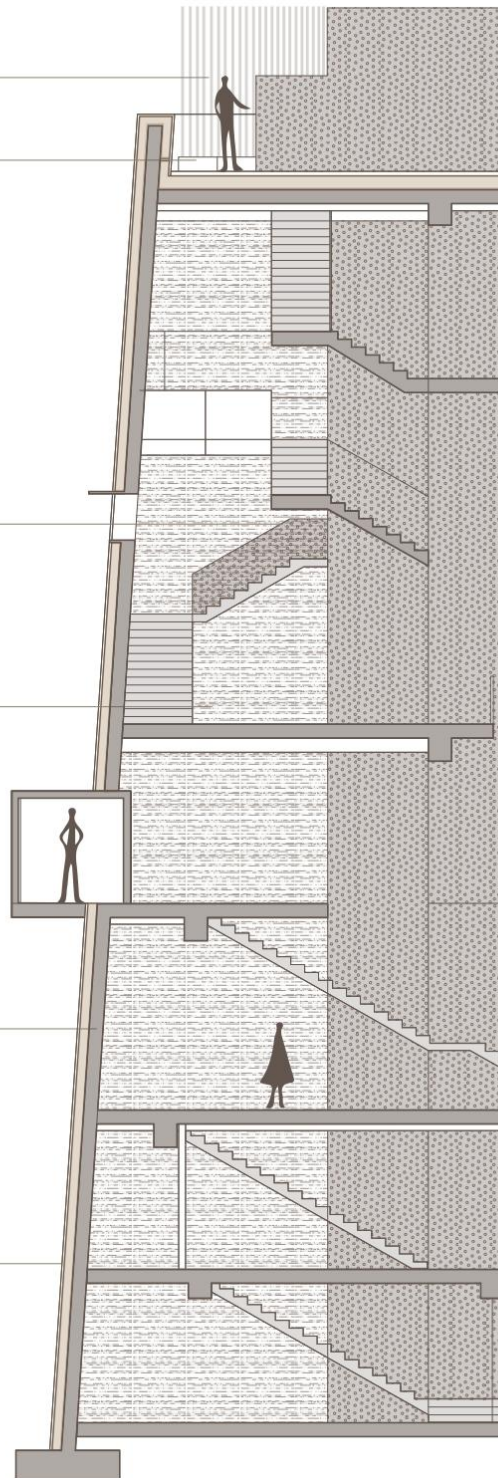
Corte Fachada Knut Hamsun Center (Autoría Propia 2025)
